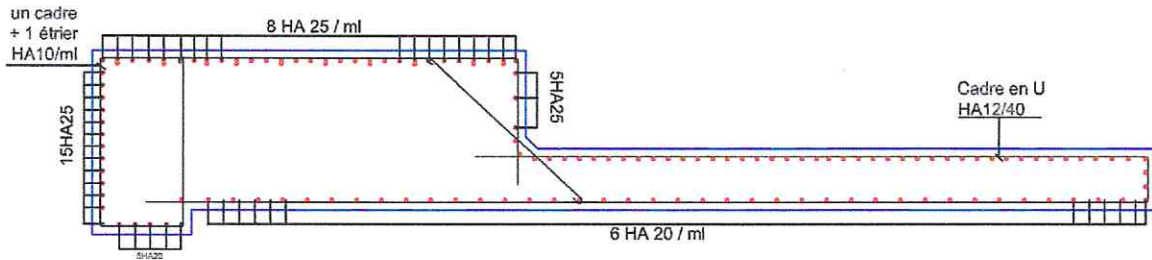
Plan de ferrailage de la poutre de couronnement
